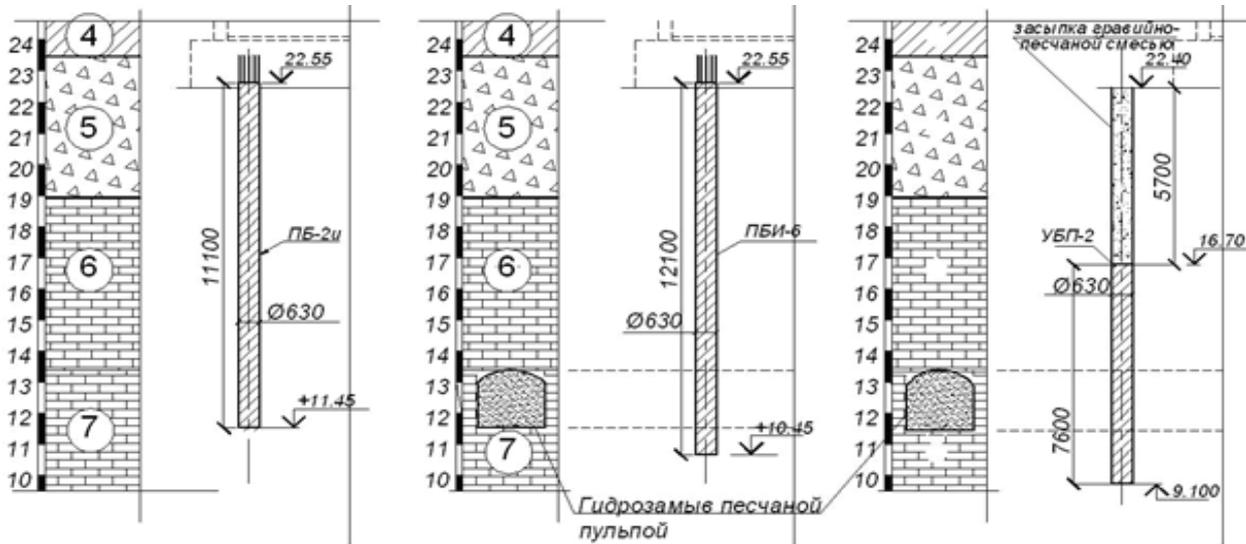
Схема устро́йства свай: а – робоча свая вне зоны выработки; б – робочая свая в зоне выработки; в – свая усиления
